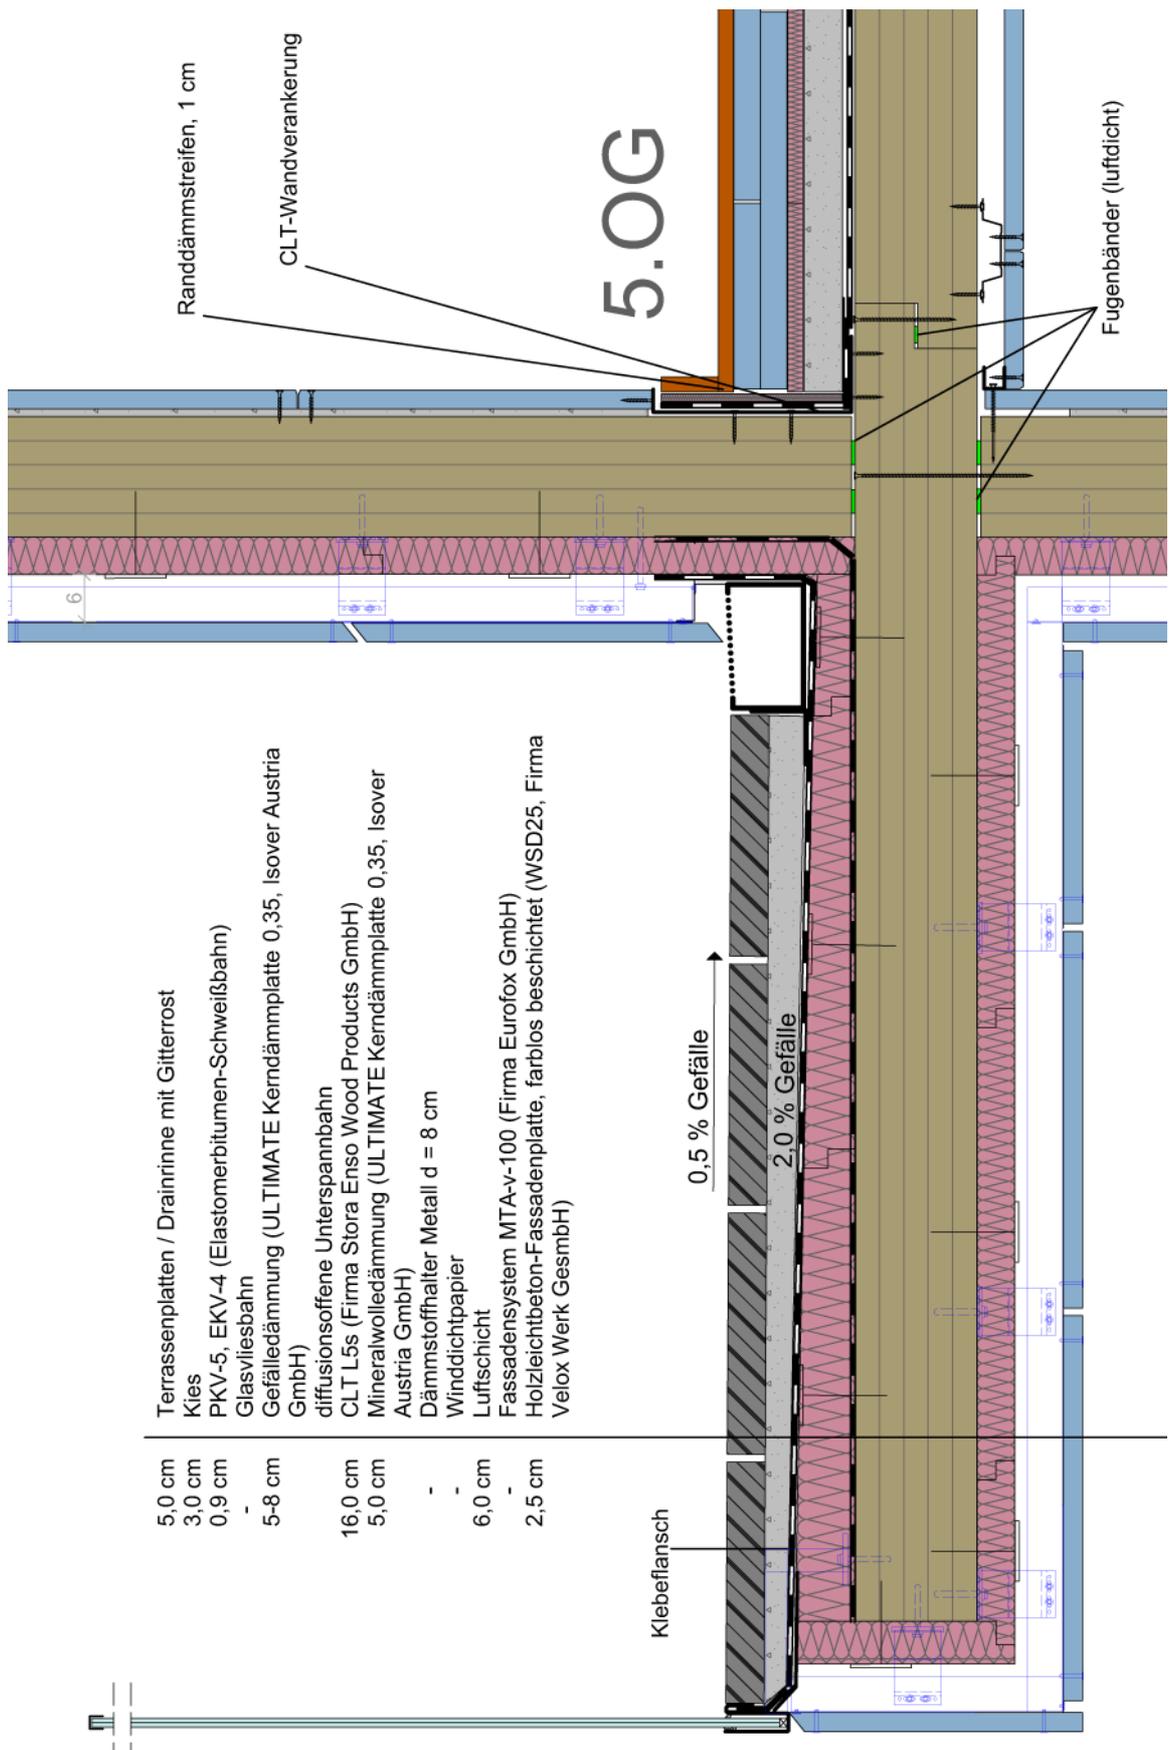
Detail 1:10 - Anschluss Außenwand- Geschoßdecke-Balkon
